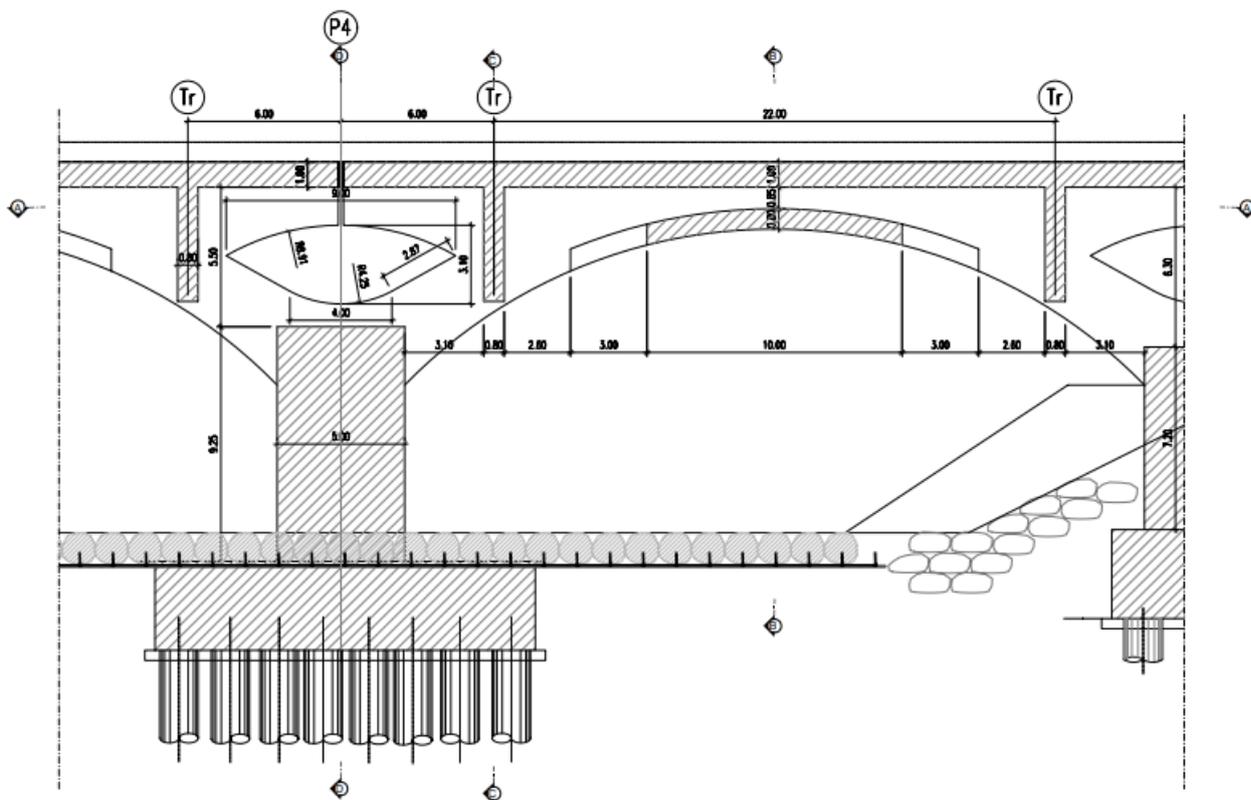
Sezione longitudinale di pila e campata in alveo
